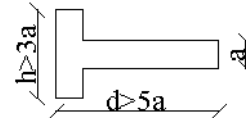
Schéma d'un voile plein et disposition du ferrailage.
